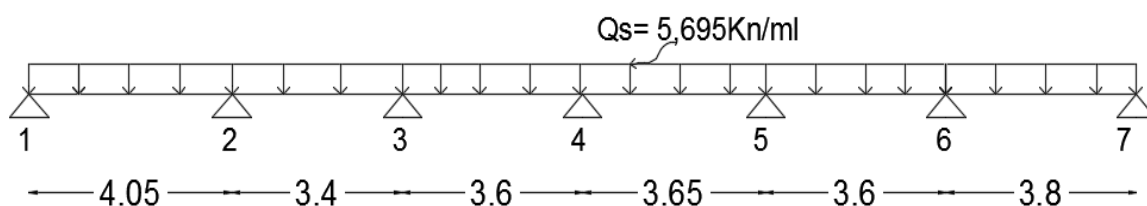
Schéma statique de la poutrelle à l'ELS.
